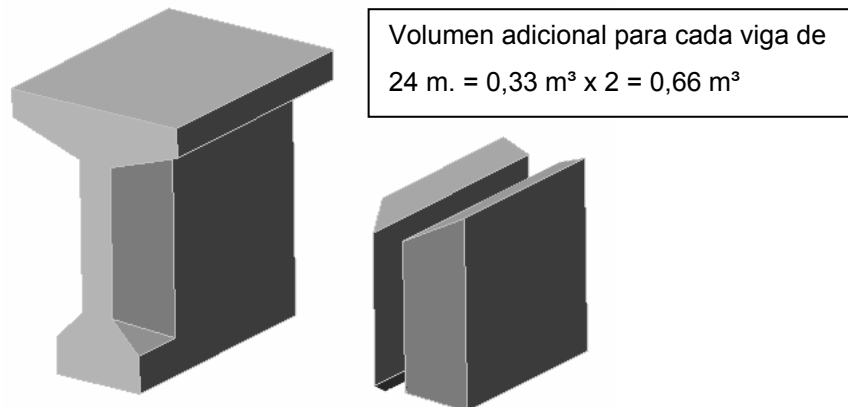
VOLUMEN ADICIONAL EN EXTREMO DE VIGA DE 24 m.
